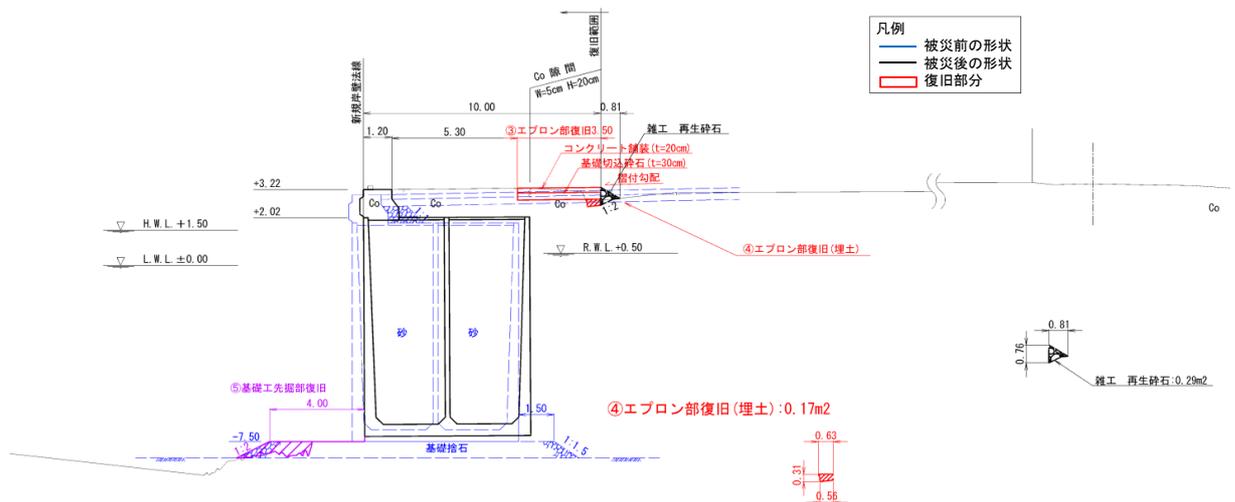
No.2 日立港区_第1ふ頭地区 1-B 岸壁 (-7.5m) の断面図 (復旧後)
